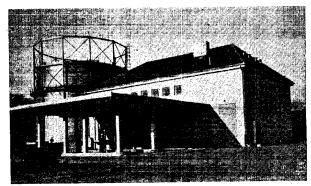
Ansicht des Maschinenhauses mit Tankstelle.
